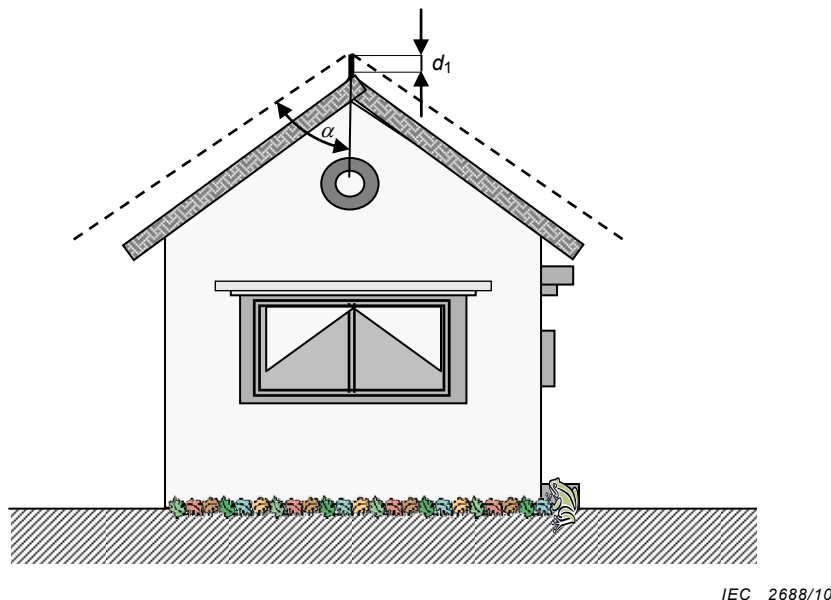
Projection sur le plan vertical perpendiculaire au plan contenant le conducteur
